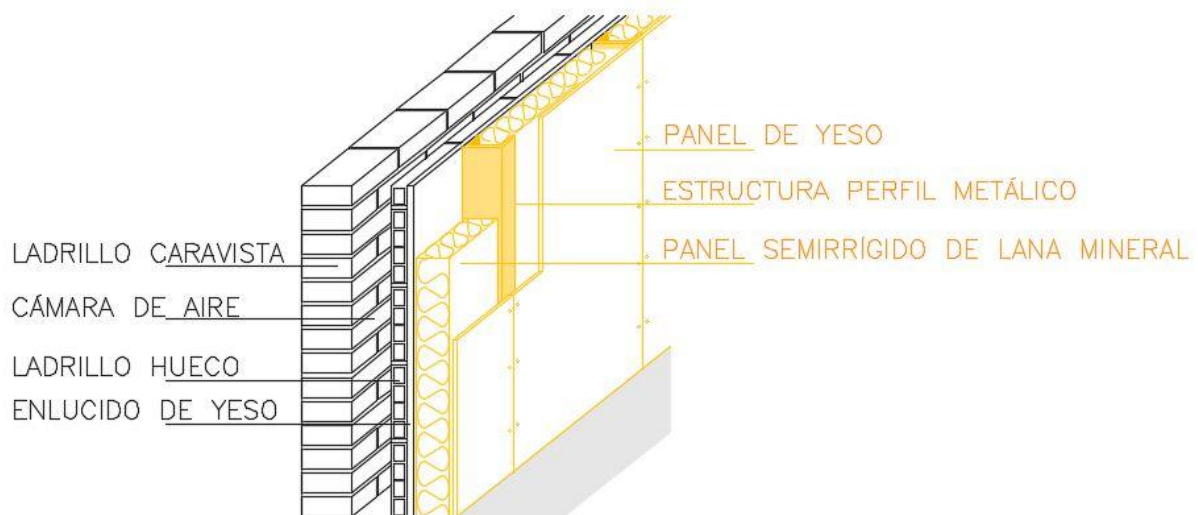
Detalle constructivo de la fachada rehabilitada. Fuente: Elaboración propia
